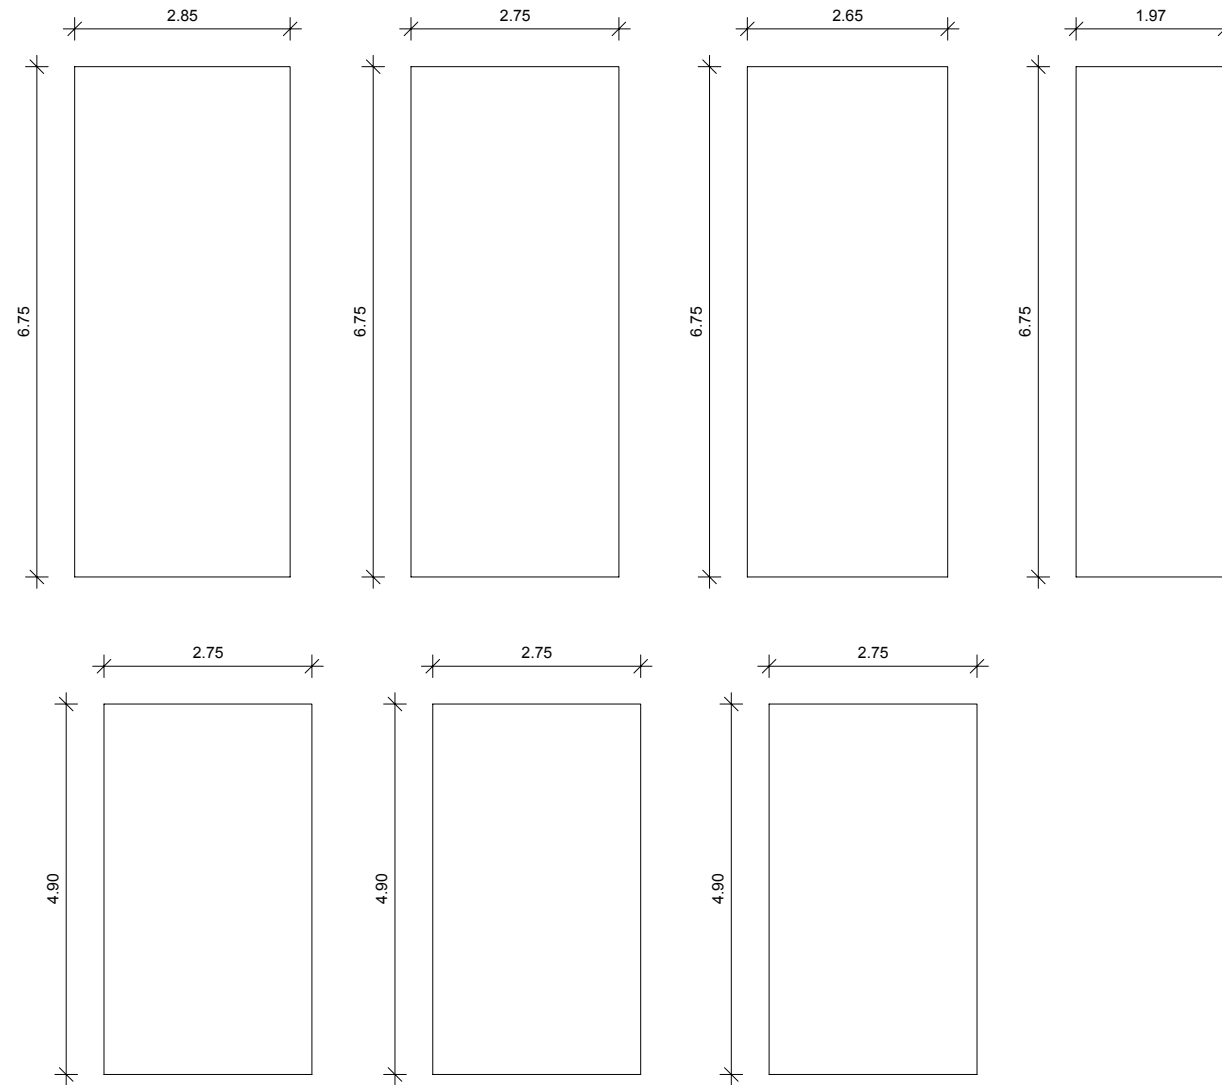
Darstellungen der CLT - Dachbauteile zu Entwurf 2
